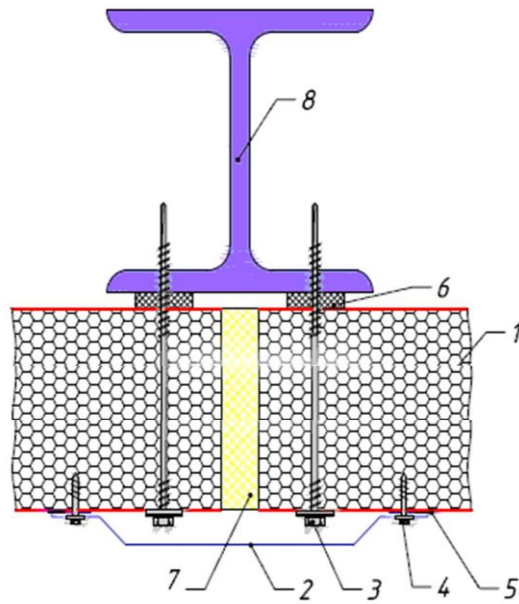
Вузол кріплення стінових сендвіч-панелей до сталевій колони
